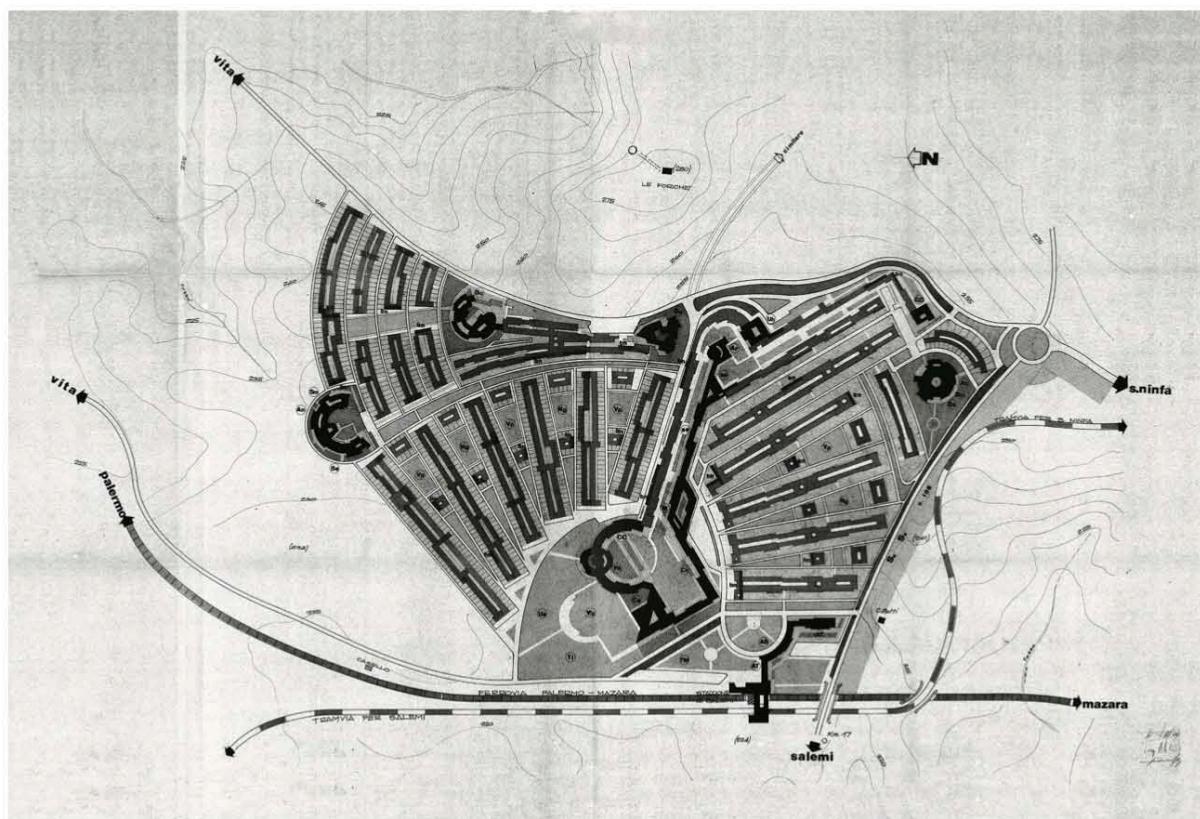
| Comune di Gibellina. Piano di trasferimento totale elaborato per conto del Ministero dei lavori pubblici – Ispettorato Generale zone terremotate – Palermo. Schema planimetrico indicativo. Planimetria scala 1:2.000. Fonte: Archivio di Stato di Palermo.
